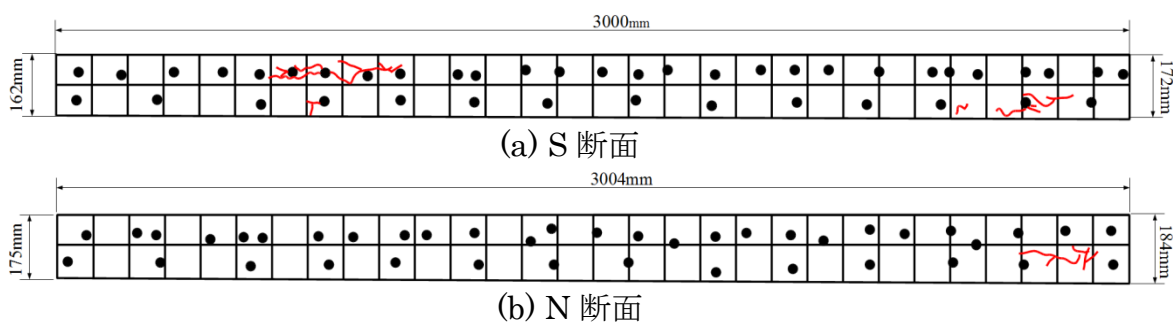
原床版切断面ひび割れ発生状況(載荷試験前)
